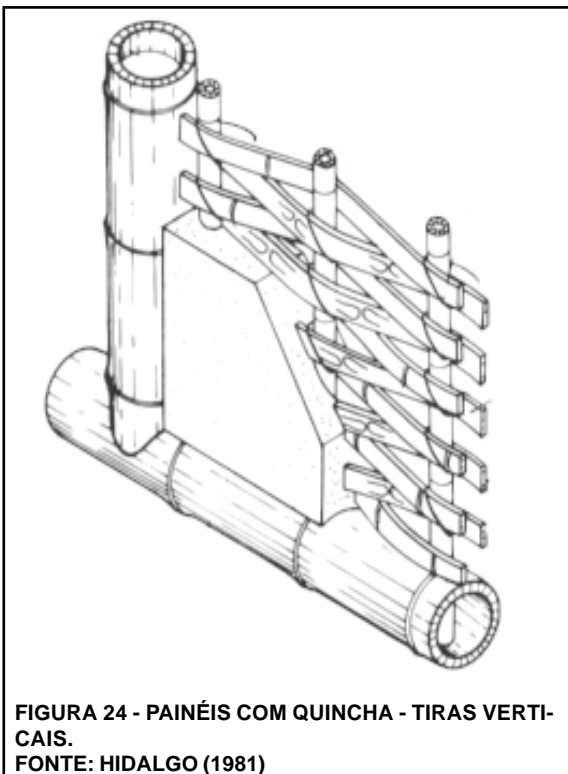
PAINÉIS COM QUINCHA - TIRAS VERTICAIS.
